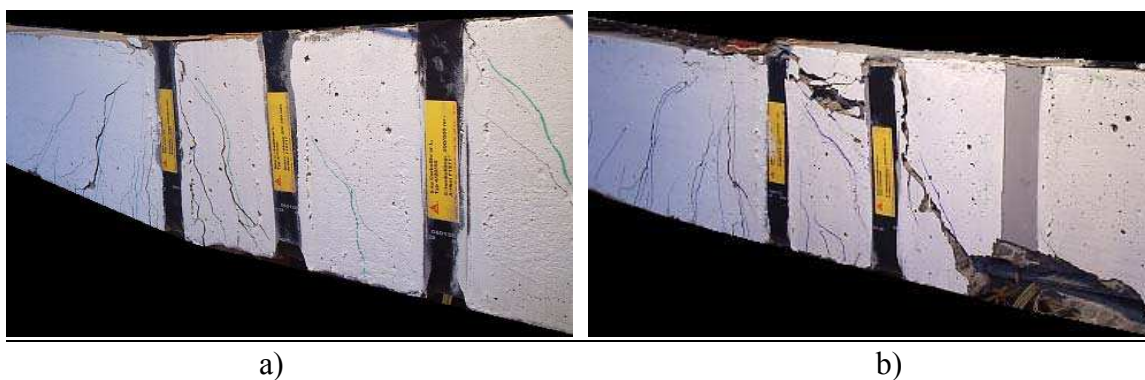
Vigas após ensaio do Sistema Sika® CarboShear L: a) entre estribos e b) sobre estribos.
